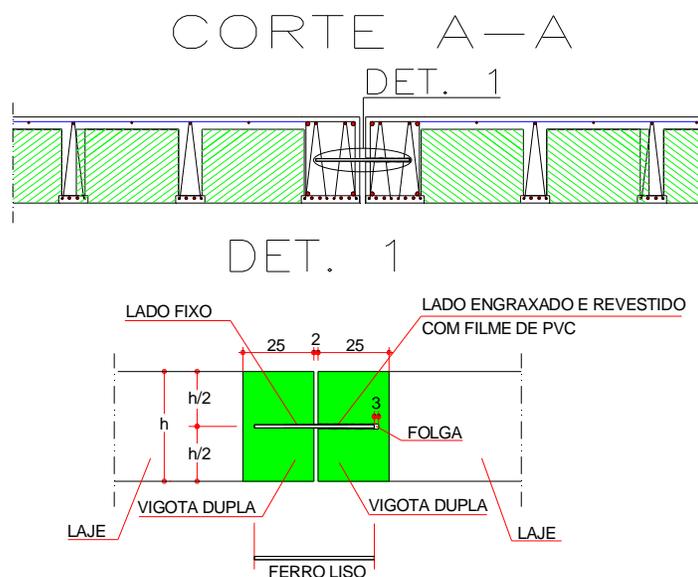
Detalhe em corte da junta de dilatação.
